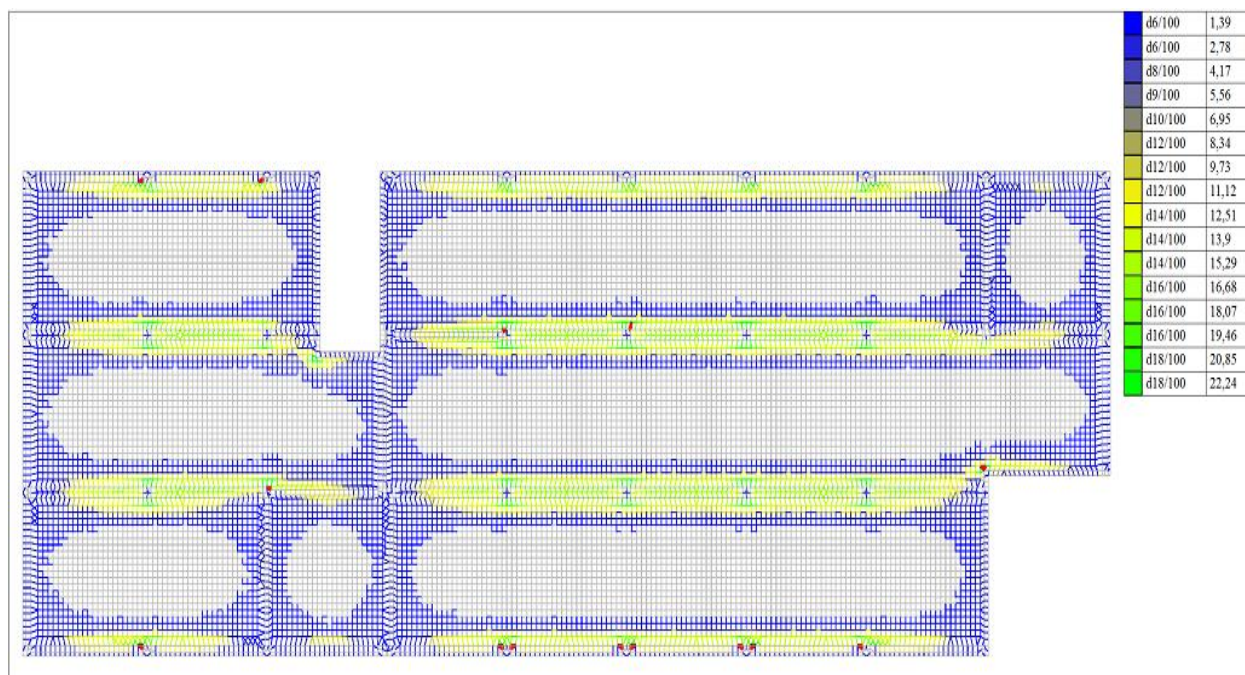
Схема верхнего армирования плиты по оси у
